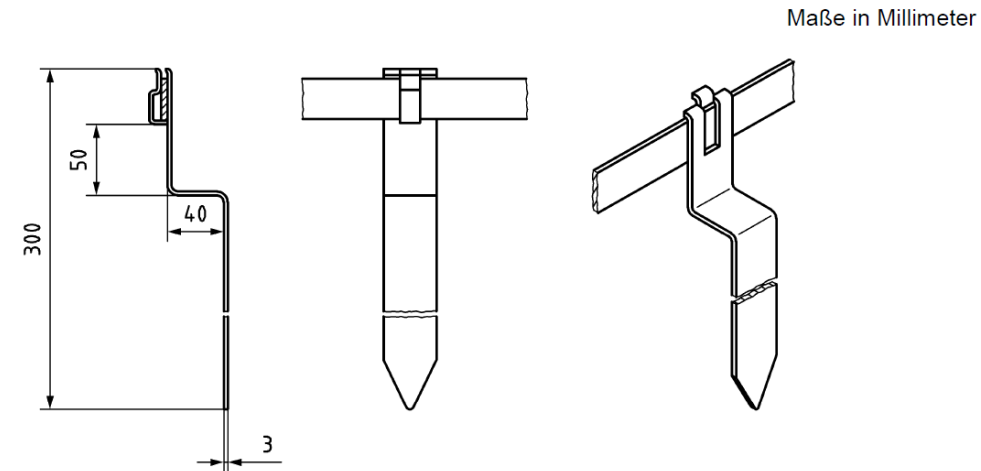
Beispiel eines Abstandhalters für Fundamenterder
